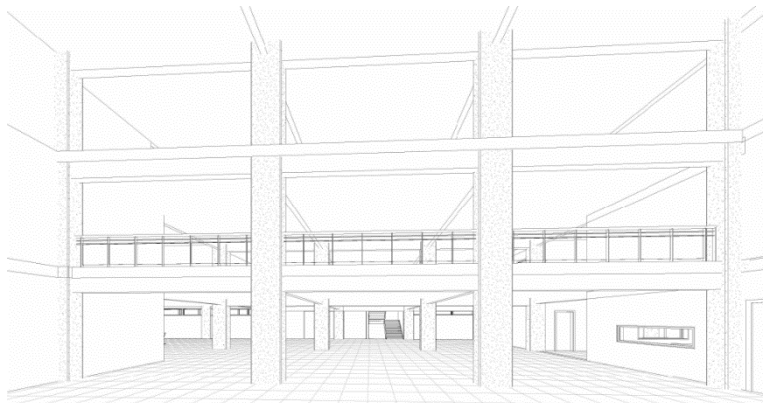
Imagen del acceso propuesto, donde se retiran losas y vigas generando la triple altura (2021)
